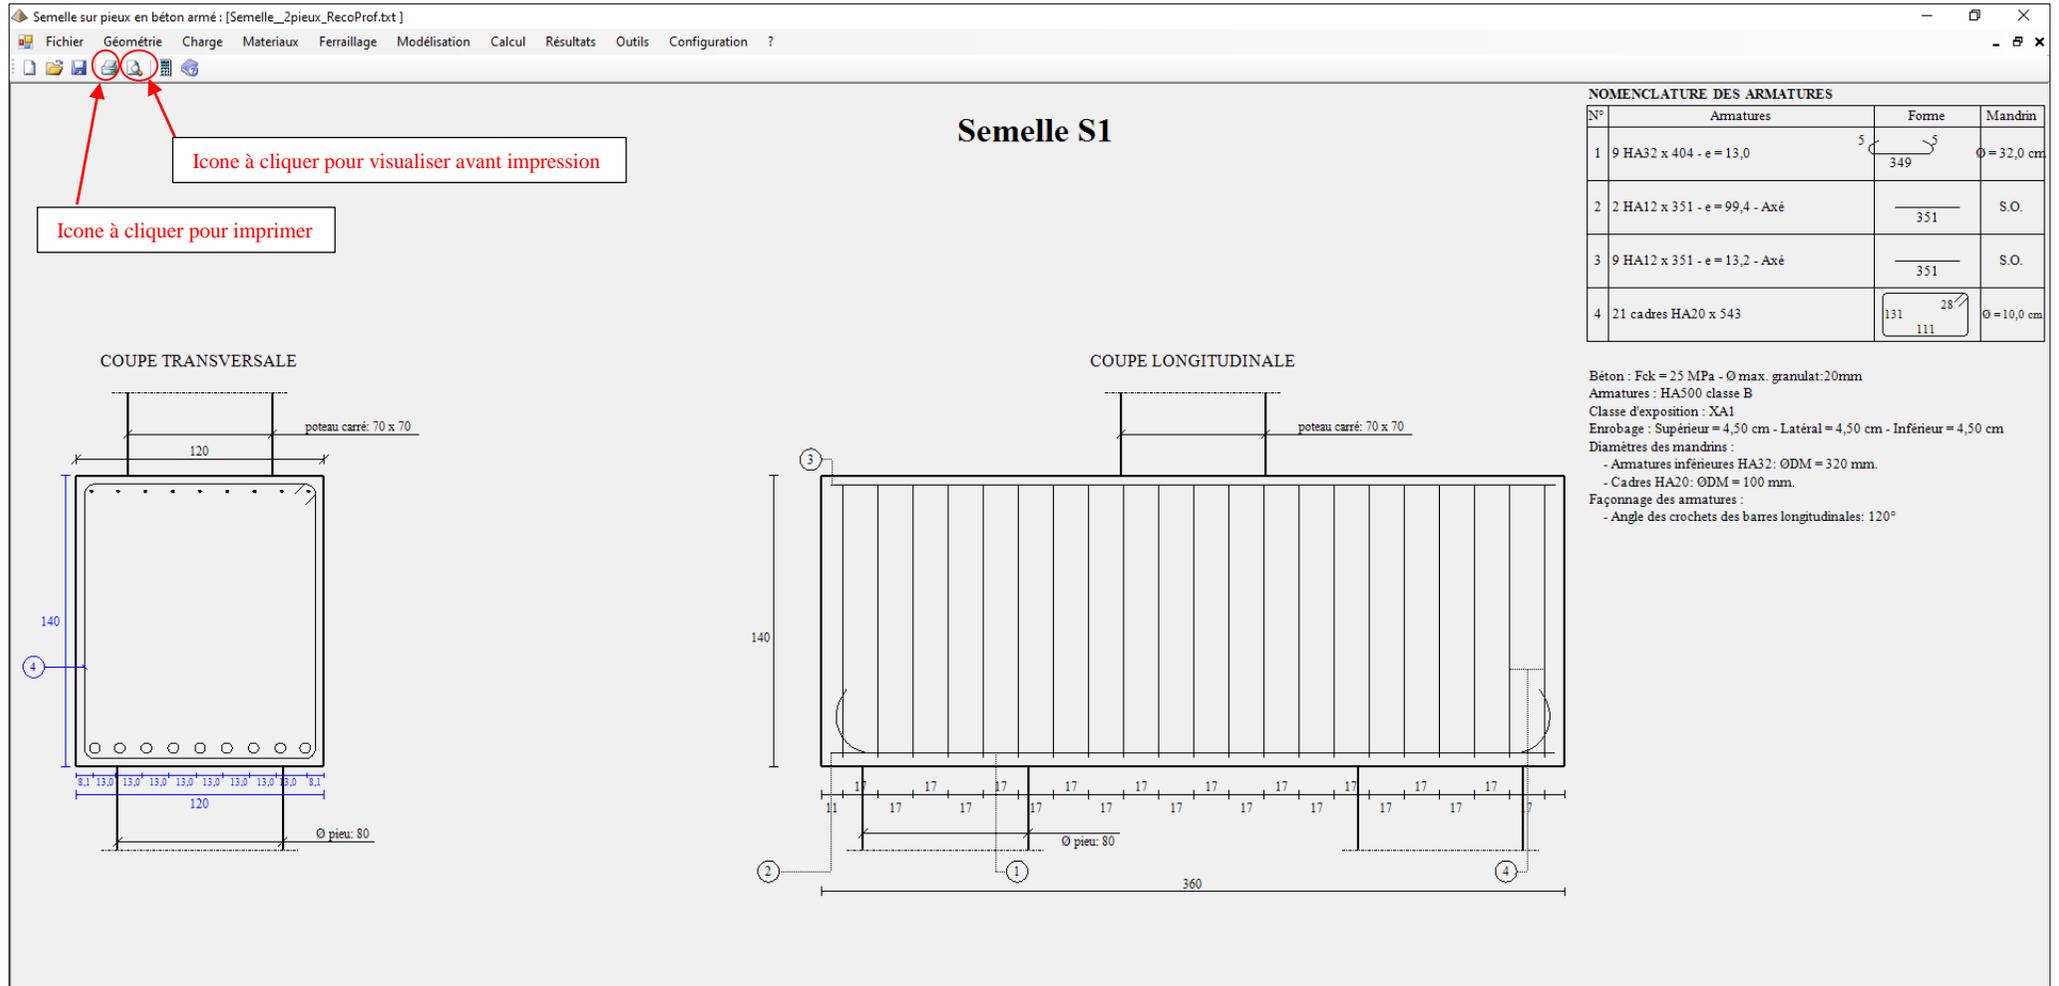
Ecran du plan de ferrailage d'une semelle sur deux pieux
